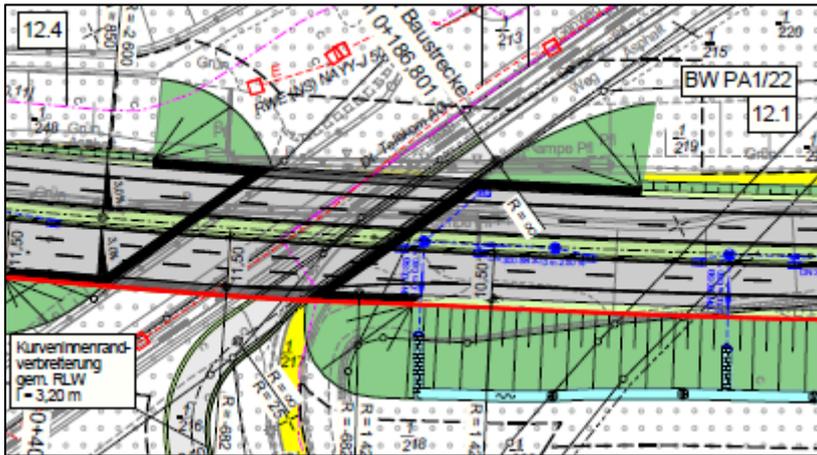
BW PA 1/22 - Ausschnitt Lageplan, U 5, Bl. 12
